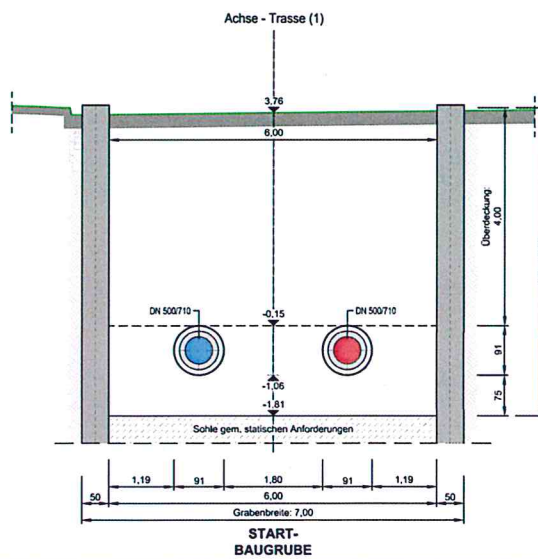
U_SR Schnitt (Auszug aus dem Plan Nr. 4.22.3.2b, Rev_f)
